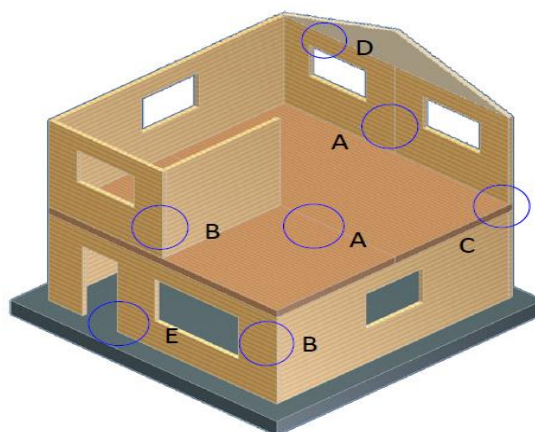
Construção com painéis CLT em dois pavimentos e regiões de conexão entre painéis. (Mohammad *et al.*, 2019)
